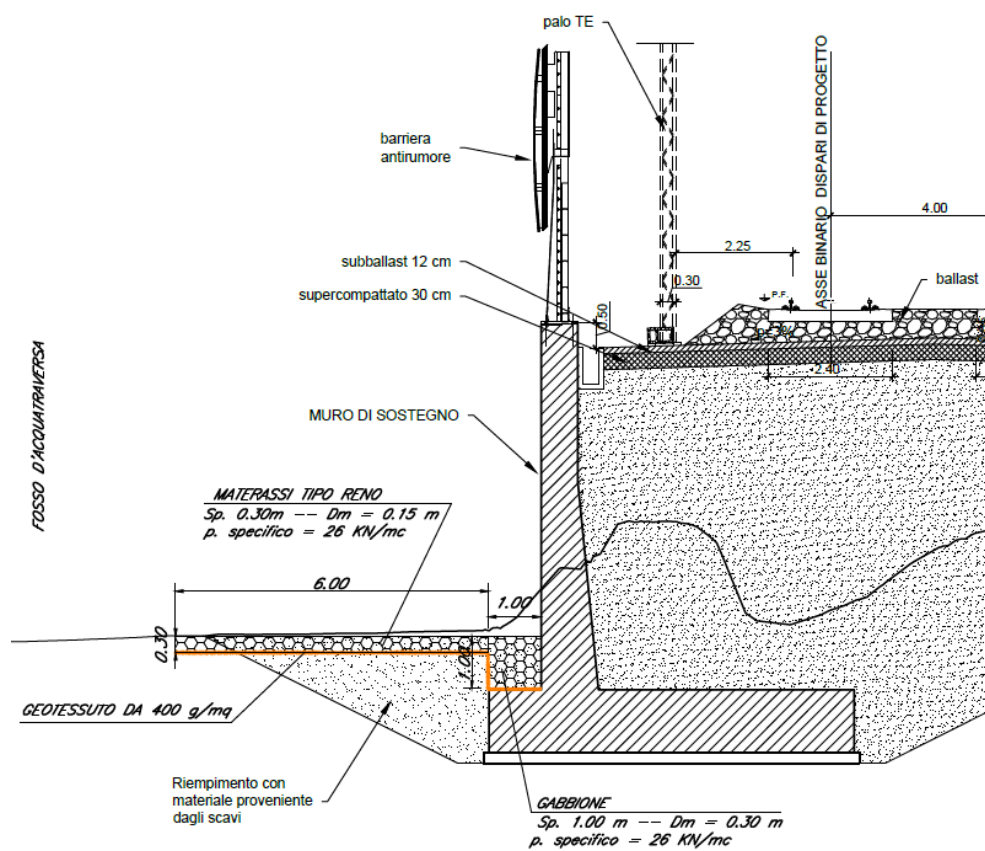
Fosso d'Acquatraversa: sezione “tipo” delle opere di protezione del rilevato.
